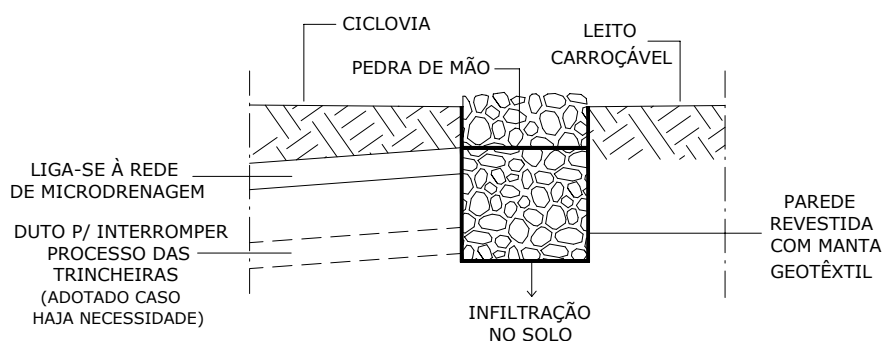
Corte esquemático de uma trincheira de infiltração.
